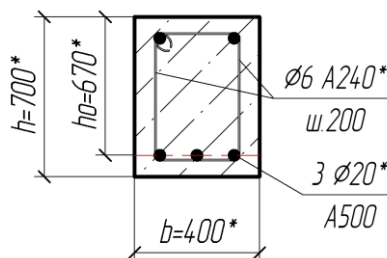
Расчетная схема поперечного сечения ж.б. балки
